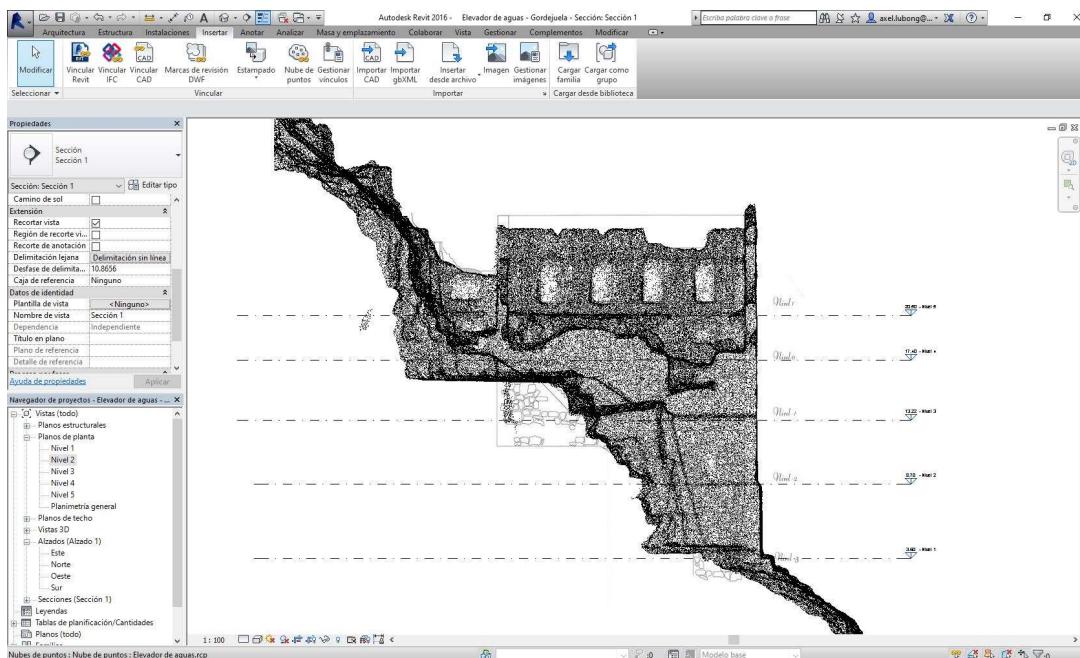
Sección nube de puntos e imagen escalada de planimetría de sección. Fuente: Elaboración propia
